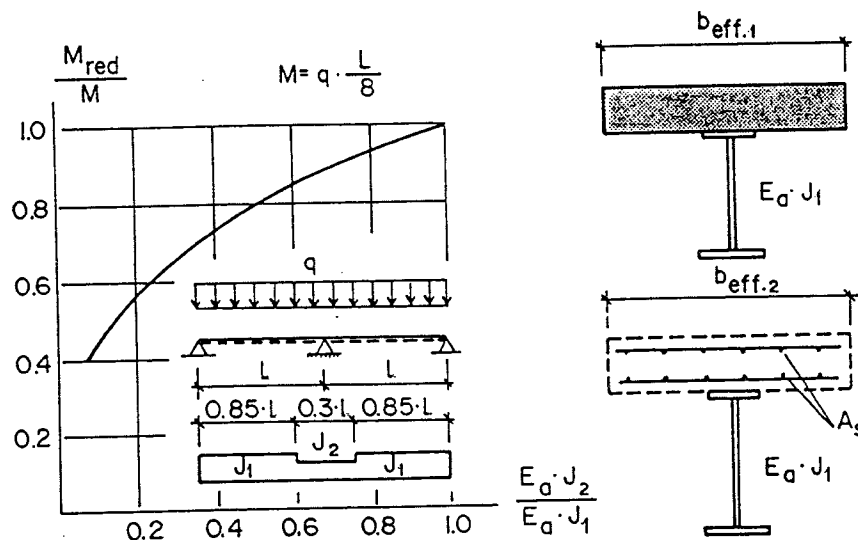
Reducción del momento en el apoyo intermedio, debido a la disminución de la rigidez de la zona fisurada de la viga.
